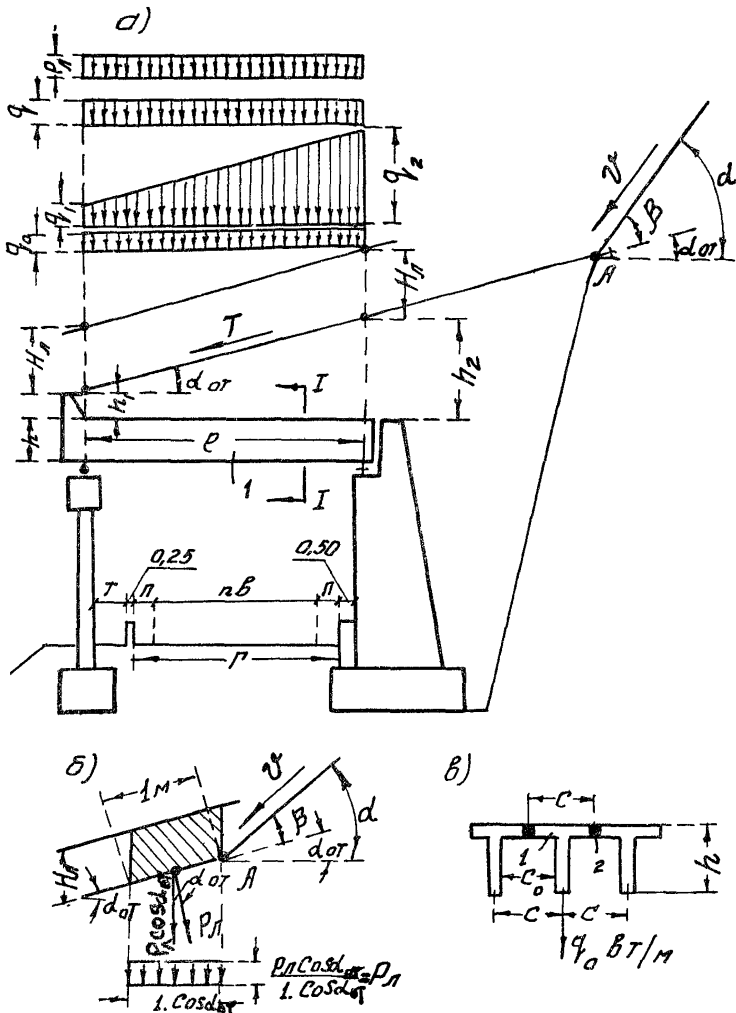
Схема нагрузок на перекрытие балочной галереи: а-схема; б-давление от удара снежной лавины; в-разрез I-I; 1-Т-образный блок перекрытия; 2-стык блоков перекрытия
